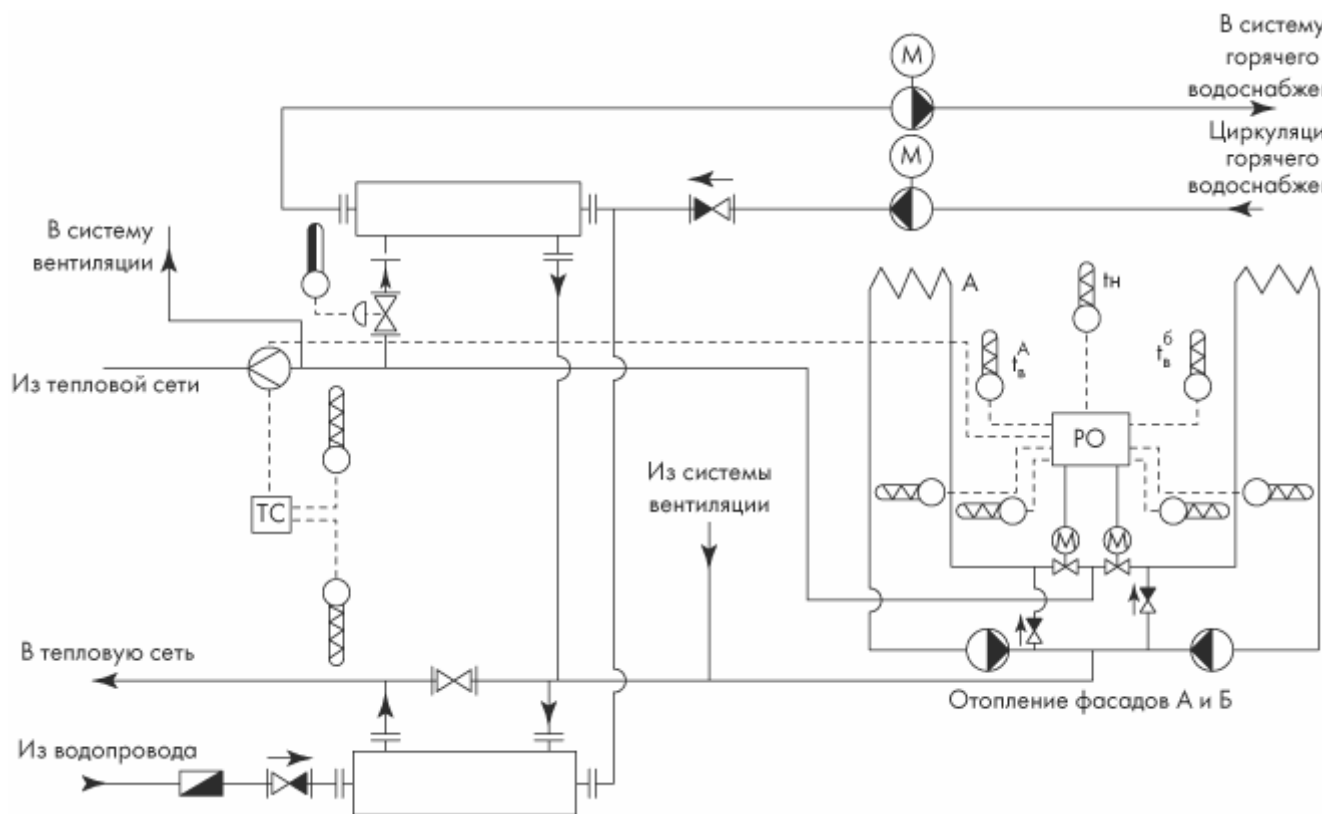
Тепловая схема ИТП с пофасадным регулированием систем отопления
